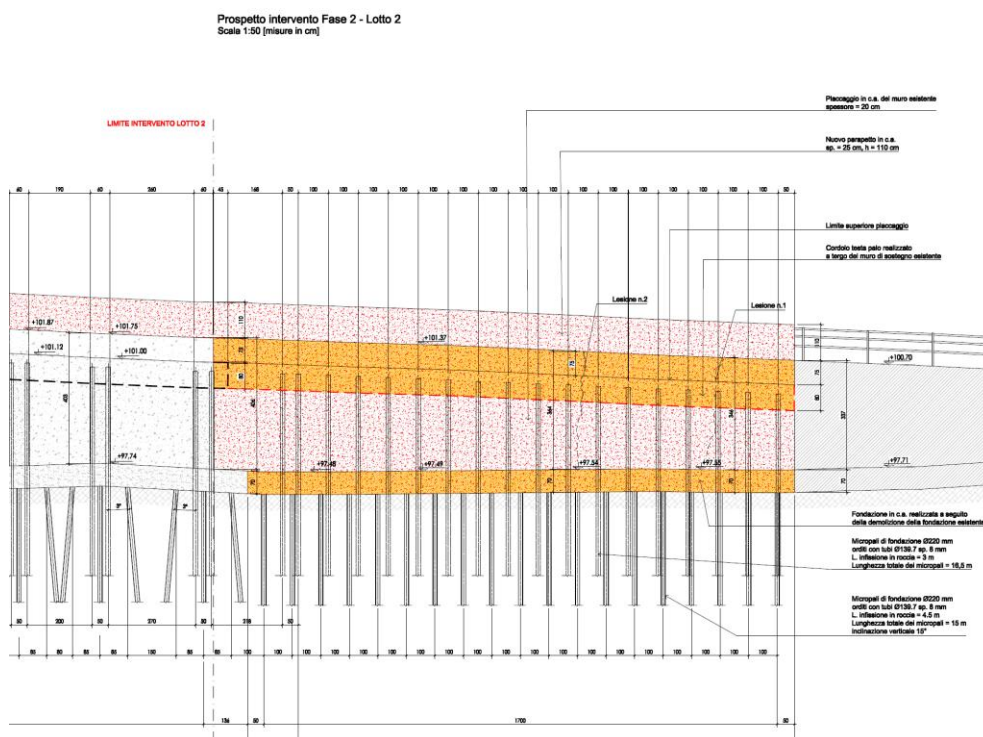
Prospetto raffronto intervento Lotto 2 – Fase 2
